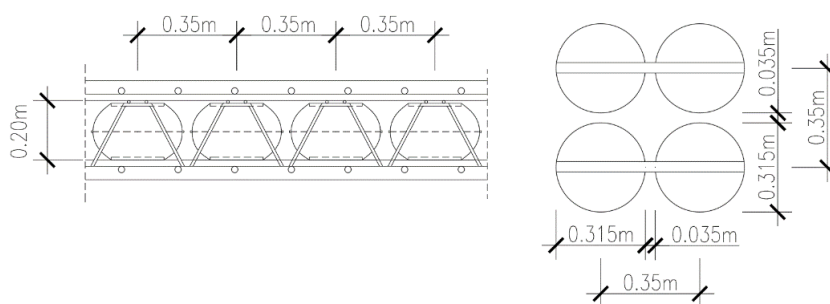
Pormenor CBCM-S-200 [14]: esquerda: corte; direita: planta.
